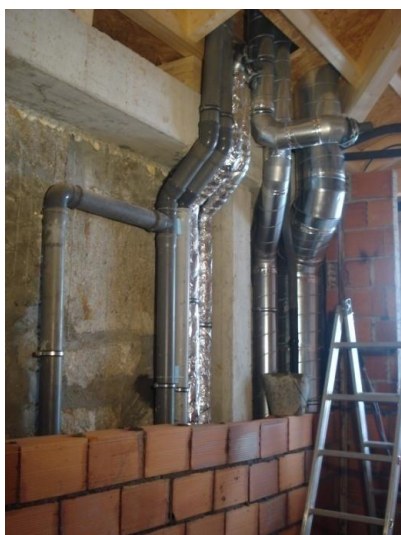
“Galeria técnica” (Sara Ferreira, 2013)
